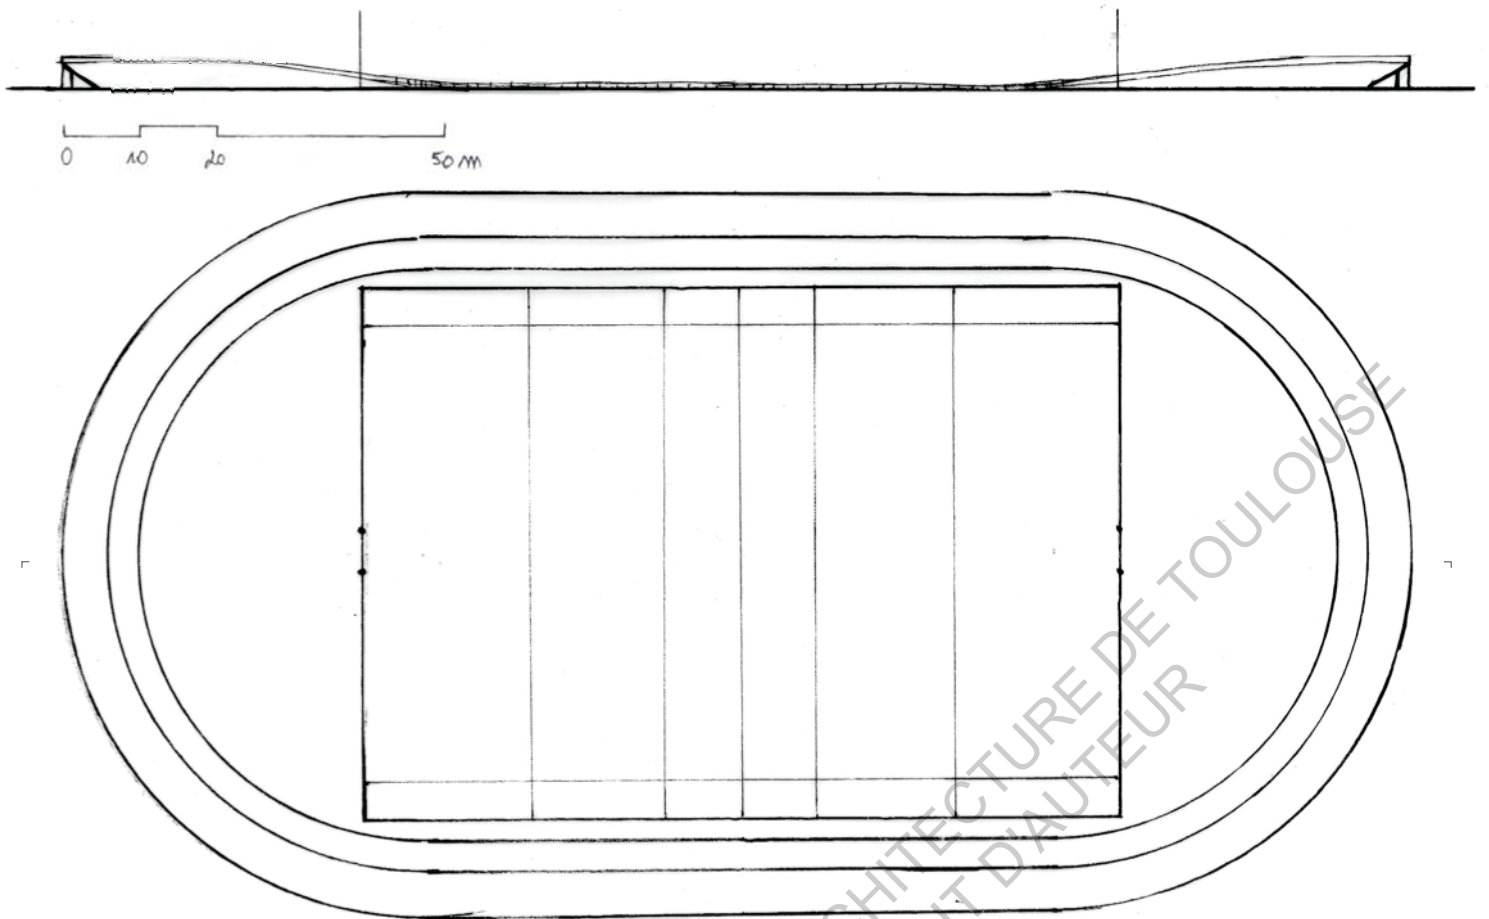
Plan et coupe du vélodrome : piste cycliste, piste athlétique, terrain de rugby
